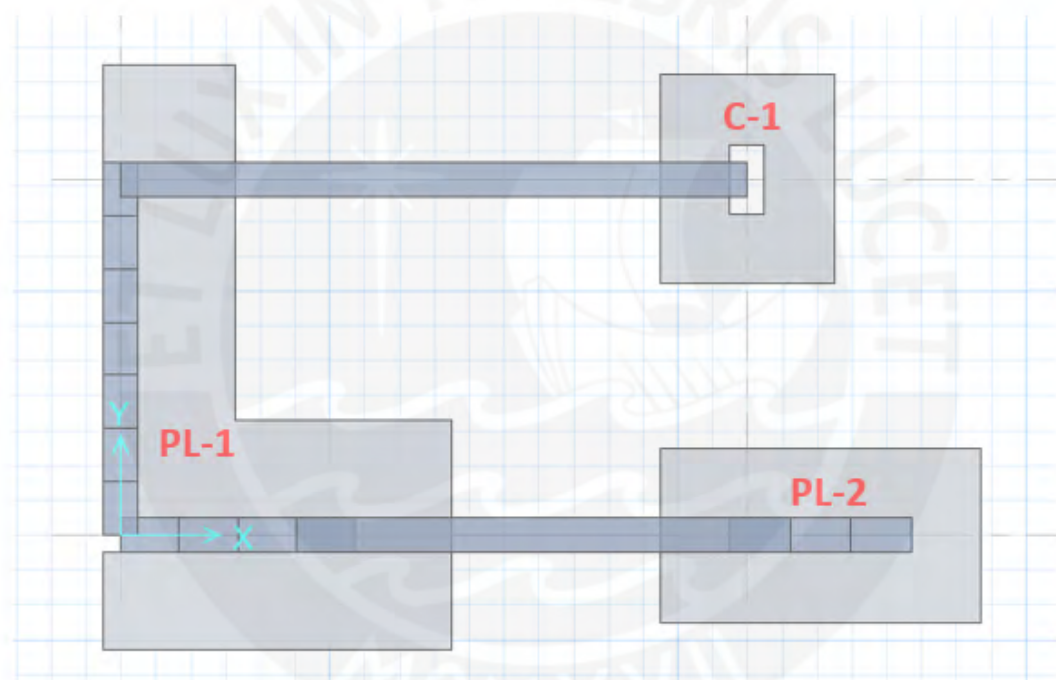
Modelo estructural para diseñar las zapatas conectadas y vigas de cimentación
